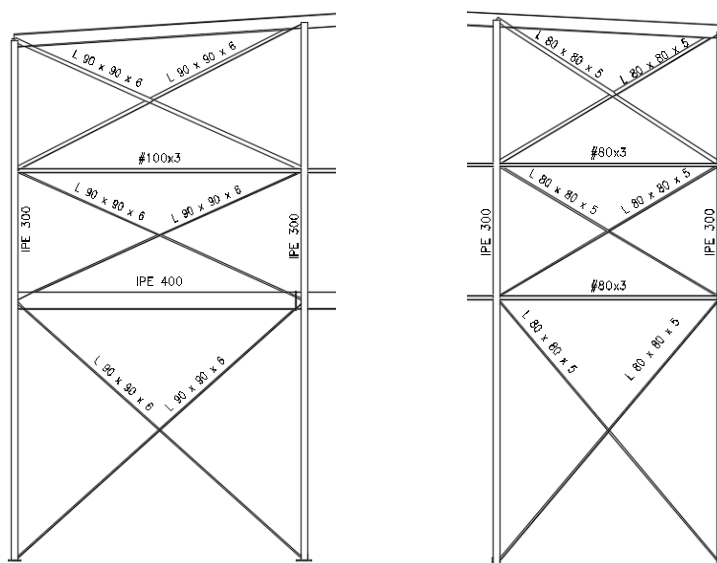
Arriostramiento Pórtico de Fachada A. (Fuente: Cype 3D)
